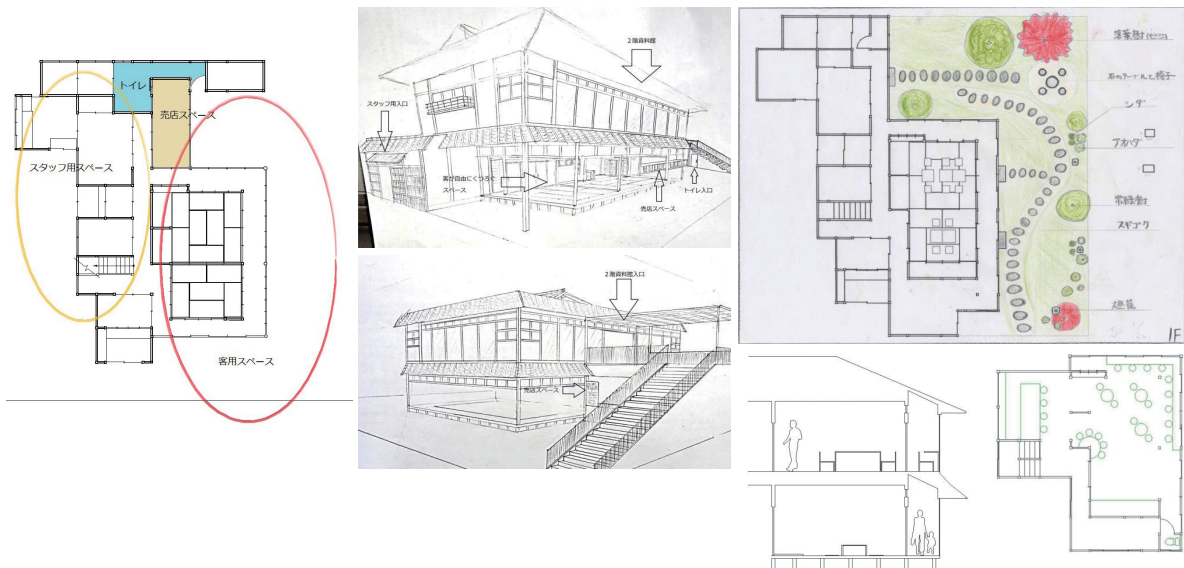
ゾーニング、パース、配置図・平面図・断面図
